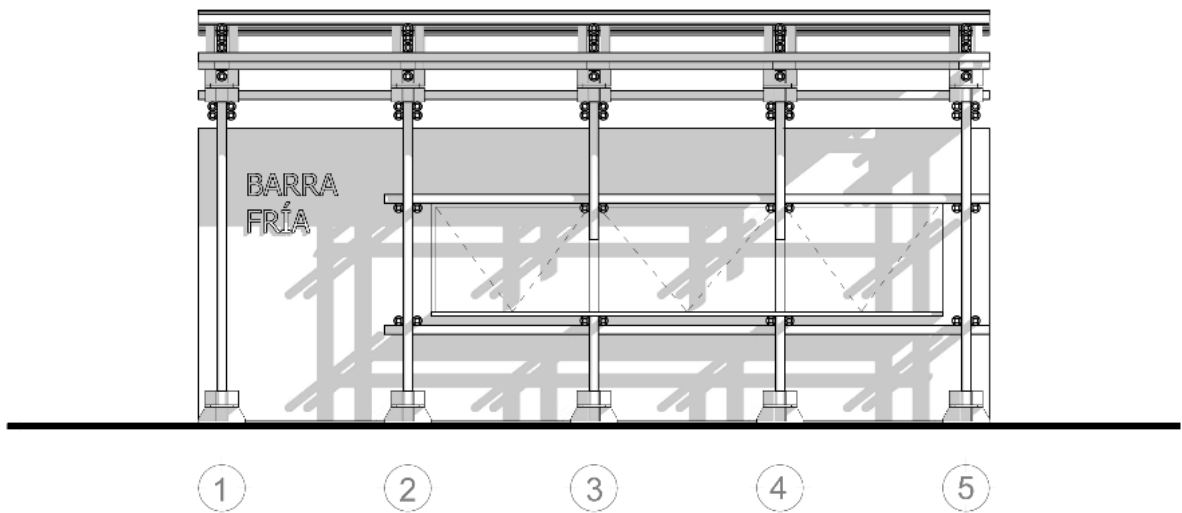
Fachada Oeste. Fuente: Gerardo A., 2022.
